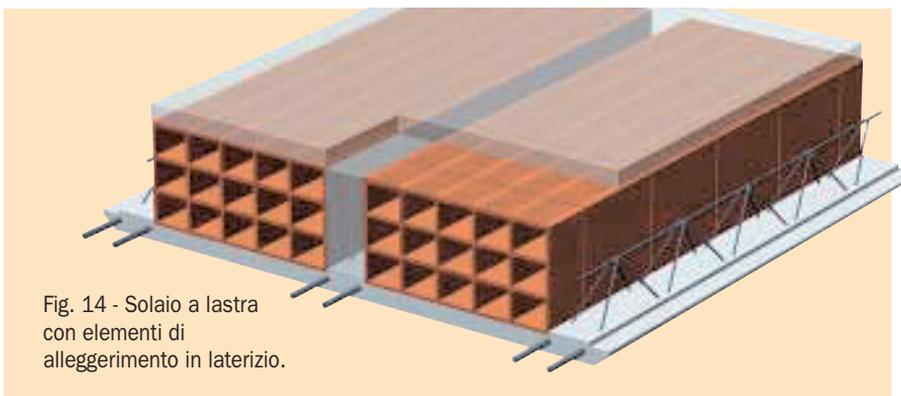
Solai a lastra con elementi di alleggerimento in laterizio.
